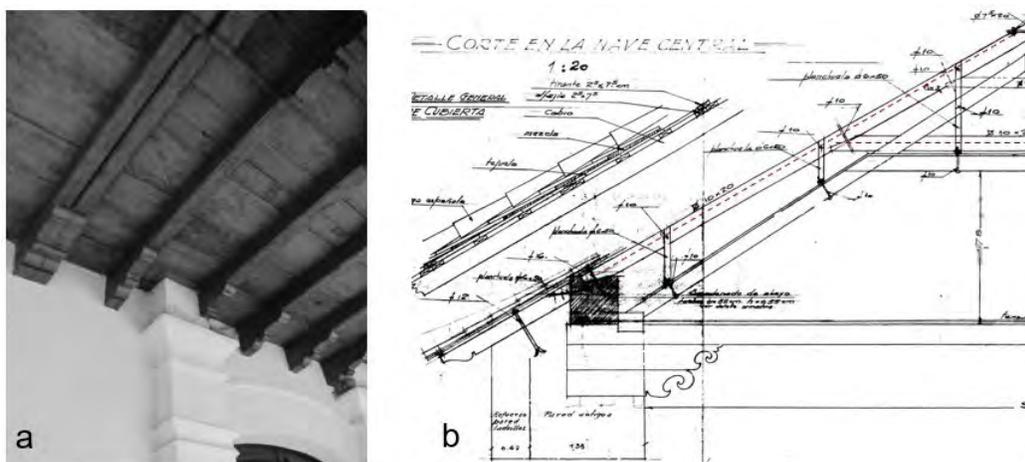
Técnicas aplicadas en la consolidación estructural. a: Estructura y entablado de la galería del cabildo utilizados como encofrado visto de la losa (oculta) del entresijo. Fotografía de la autora. b: Resolución del apoyo de los pares sobre dado de hormigón armado (rayado a 45°) y de la estructura subsidiaria de la nave central del templo de San Francisco (destacada en línea punteada) correspondientes al Plano N° 5/20 (1948). Repositorio: Archivo CeDiap
